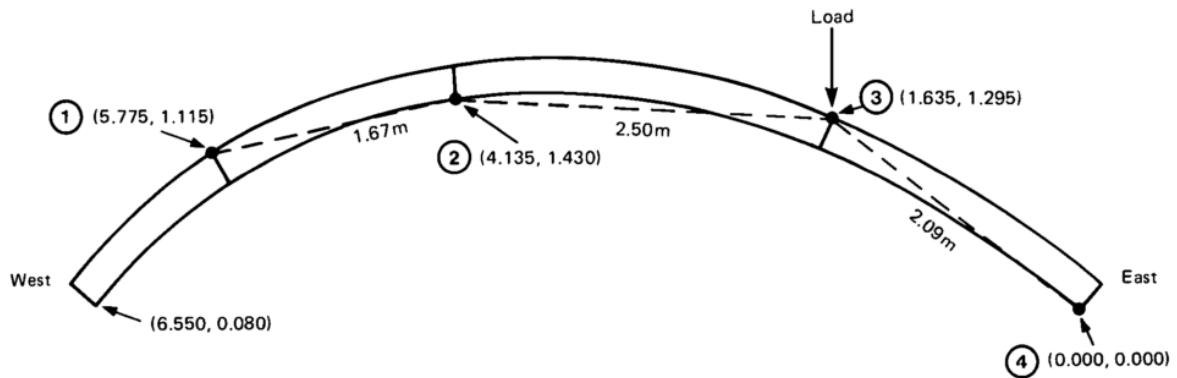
ábra – Prestwood Bridge tönkremenetel állapota [18]
